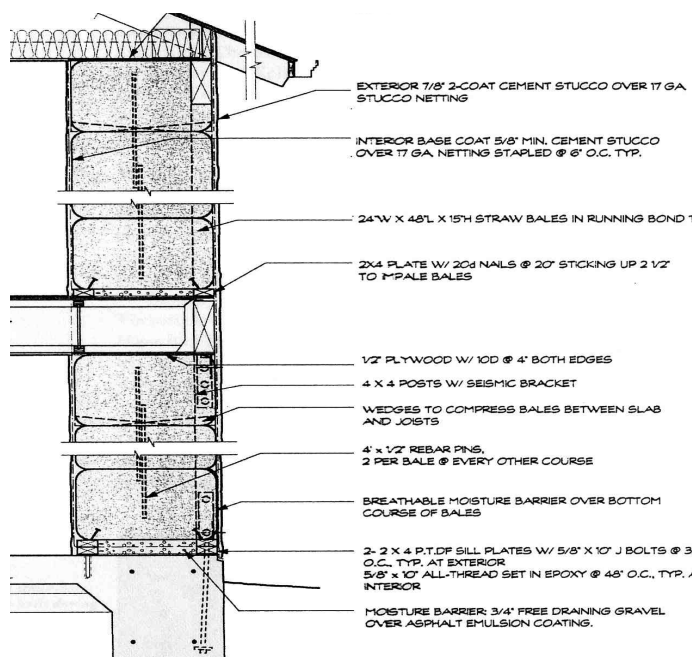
Corte construtivo de parede de palha para zona sísmica.
